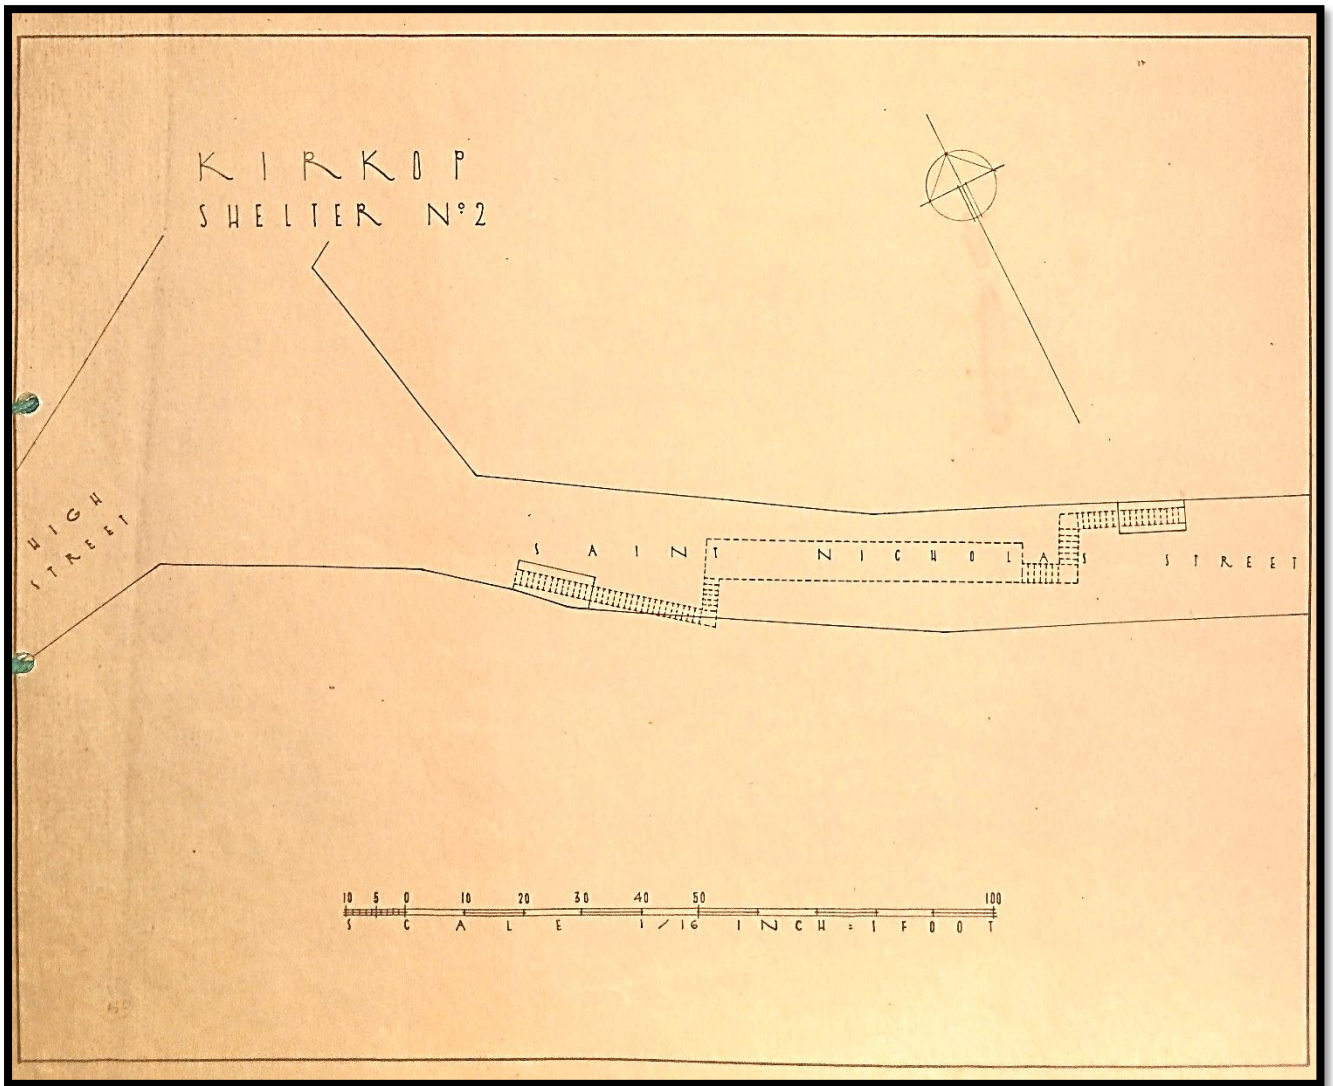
Planta do Abrigo nº2 "High Street – Saint Nicholas Street."
